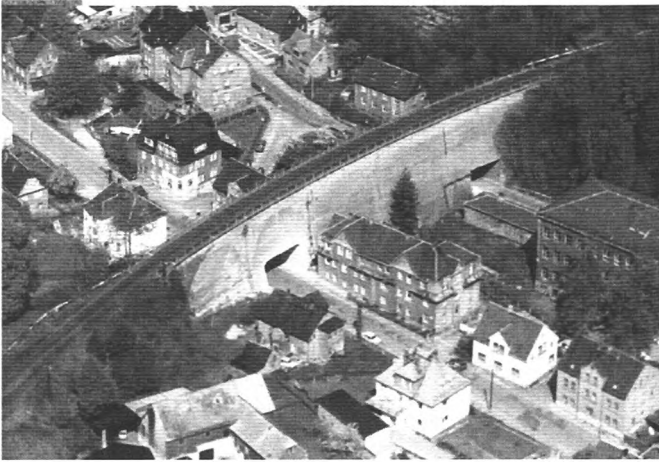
Eisenbahnviadukt (betonierte Brückenbögen zur Stabilisierung des Bauwerkes während des Bergbaus)
